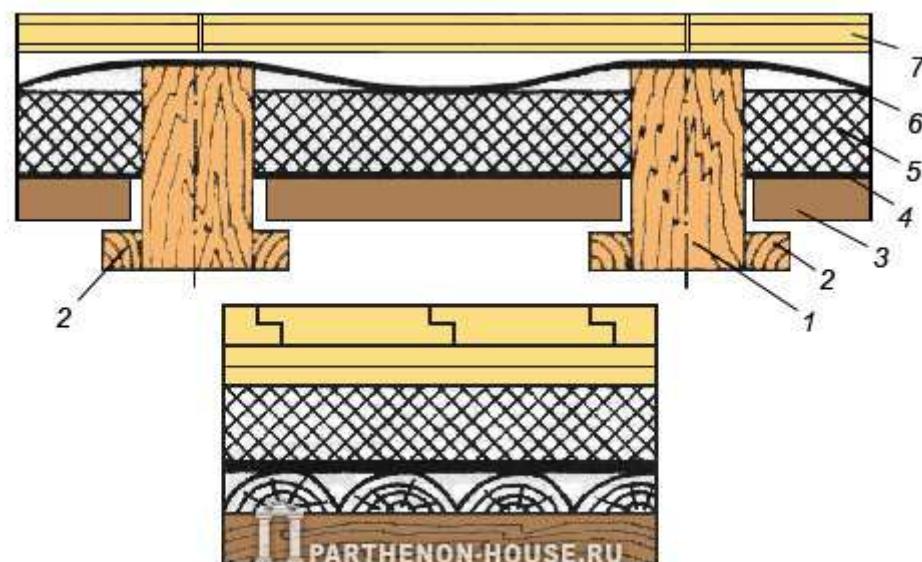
Перекрытия по деревянным балкам из цельной древесины: 1 – деревянная балка из цельной древесины, 2 – черепной брускок, 3 – деревянный щит, 4 – пароизоляция, 5 – утеплитель, 6 – гибкая прокладка, 7 – чистый пол
